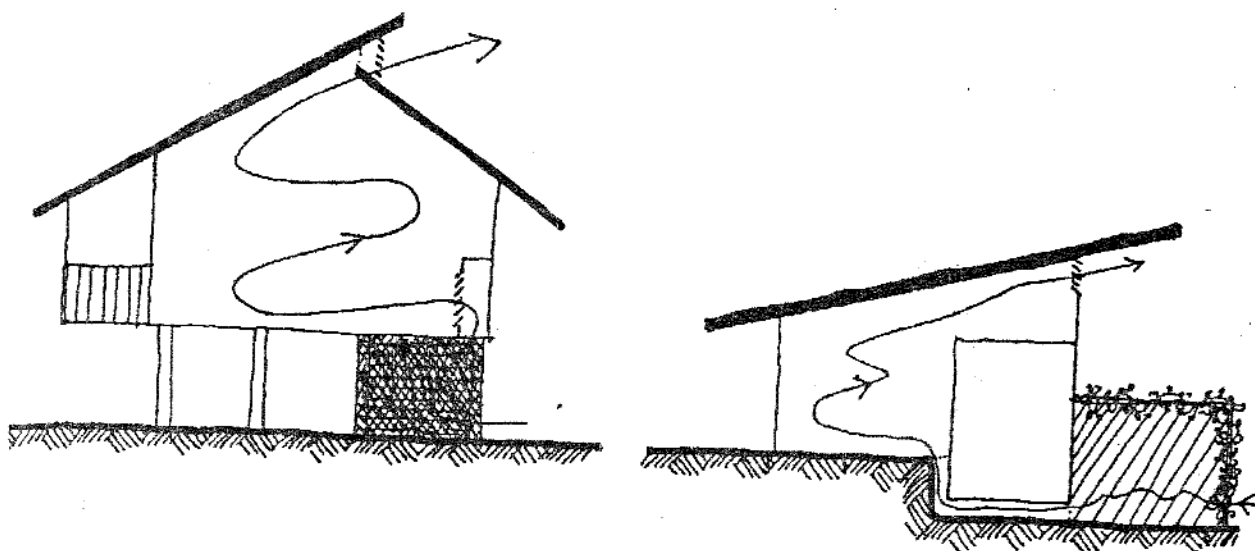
Telhados ventilados permitem o ar quente escapar e uma treliça plantada permite ao ar frio entrar.
